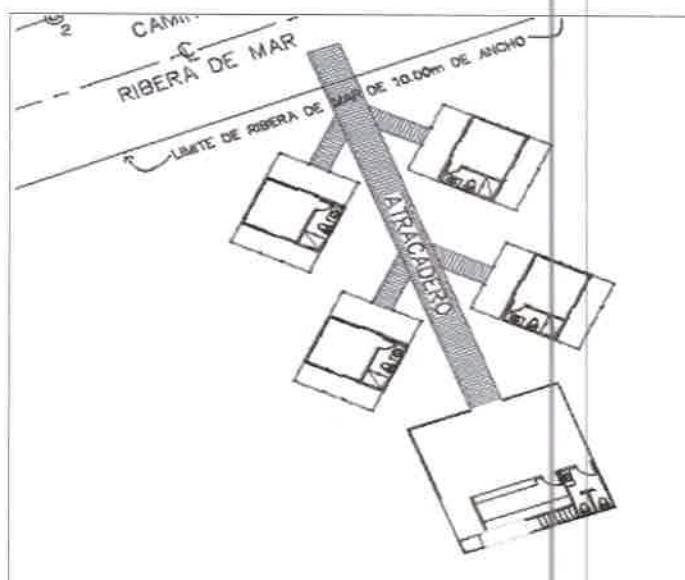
Proyección de vista superior del proyecto. Fuente: Plano arquitectónico del promotor
